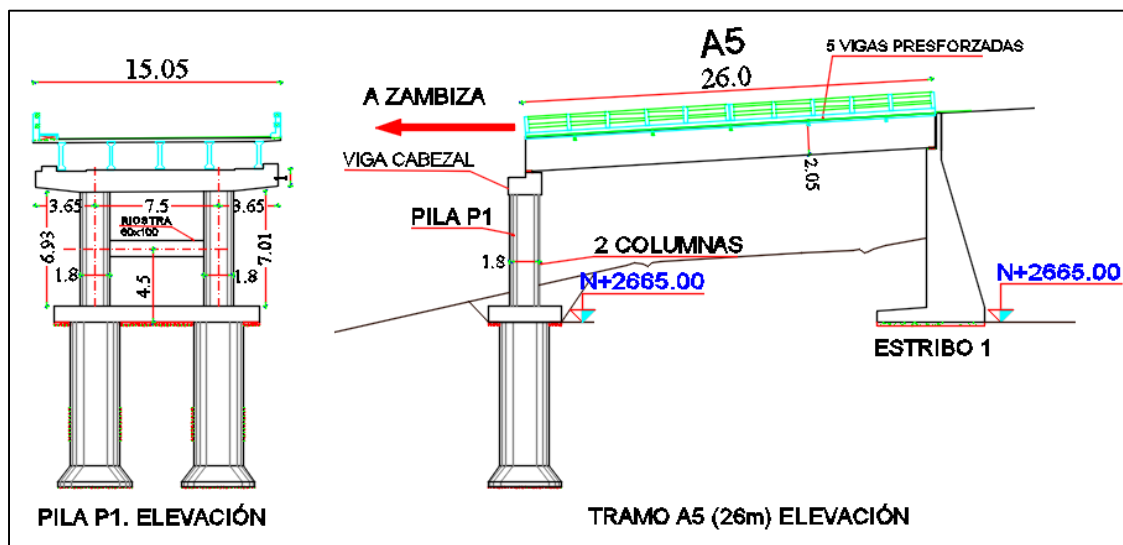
Tramo A5 (26m) y Pila P1 en elevación.
